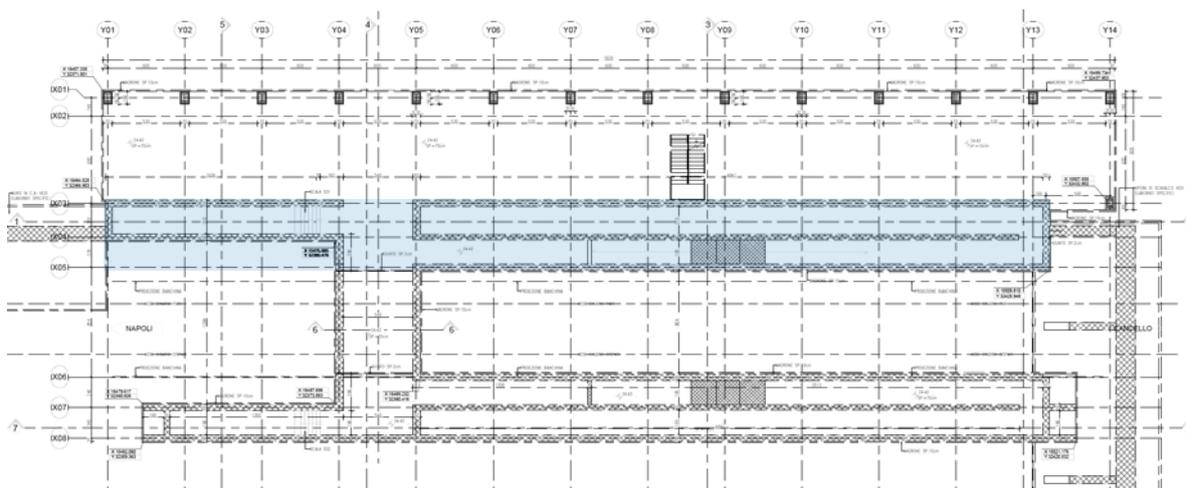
Pianta fondazioni e spiccato setti - Quota sottopasso
